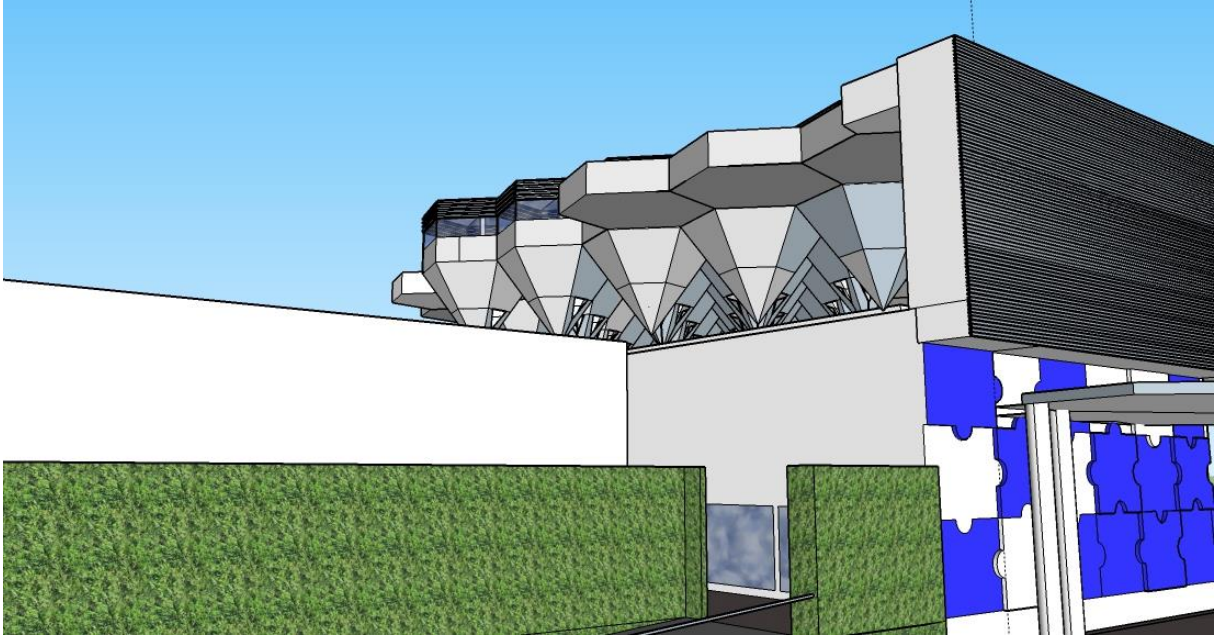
Cobertura Externa com painéis metálicos e brises do bloco 1.
